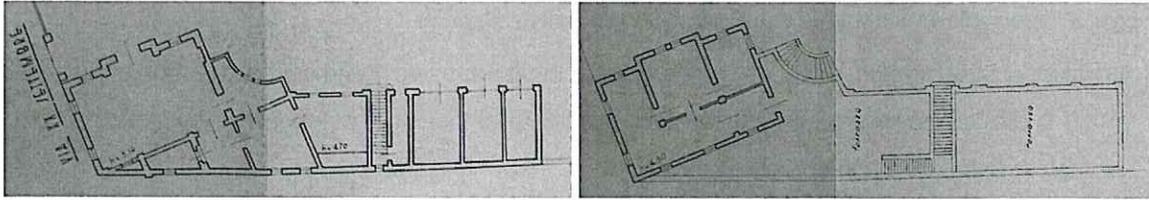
, particolari dell'edificio a est della soprastante planimetria, da sinistra: piano terra e piano primo.
